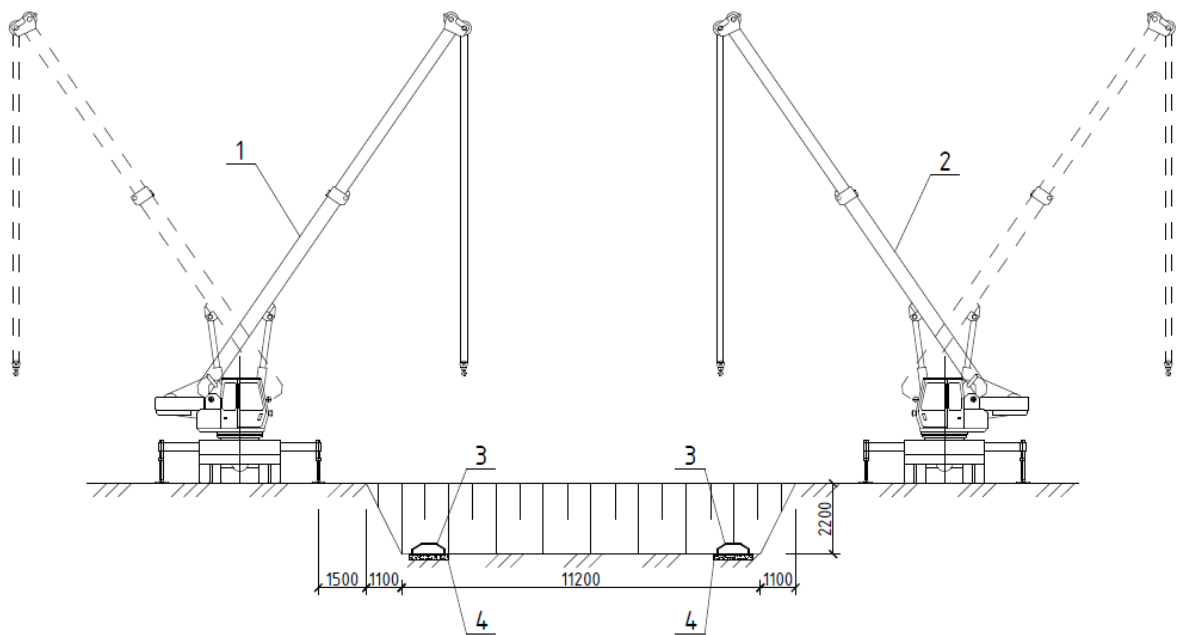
Монтаж блоков ФЛ, где: 1 - 1 предусмотренное место для установки крана, 2 - 2 место для установки крана, 3 - плиты ФЛ 10-24-2, 4 - песчаная подушка
